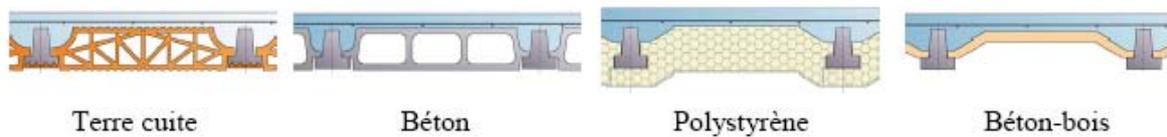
Section types d'entrevous pour planchers à poutrains et entrevous.
